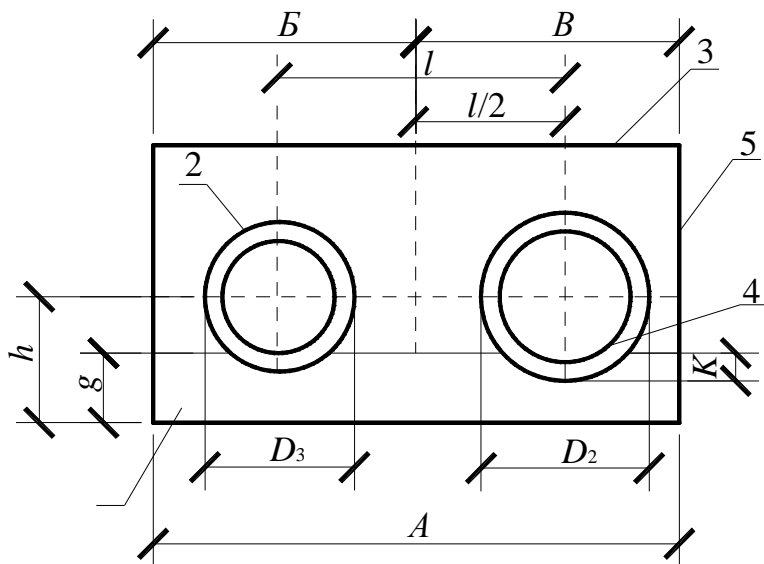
Схема безканальної прокладки теплових мереж у сухих ґрунтах:
